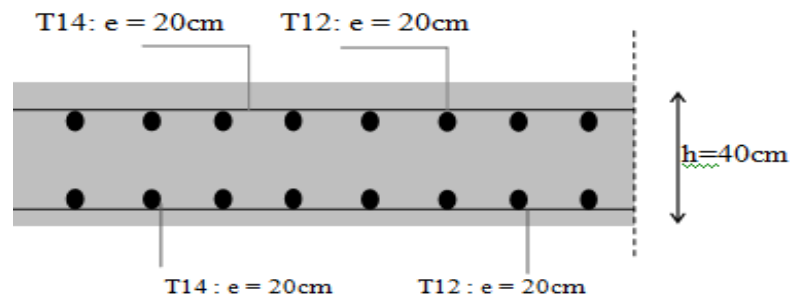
Ferrailage de la dalle du radier sens y-y
